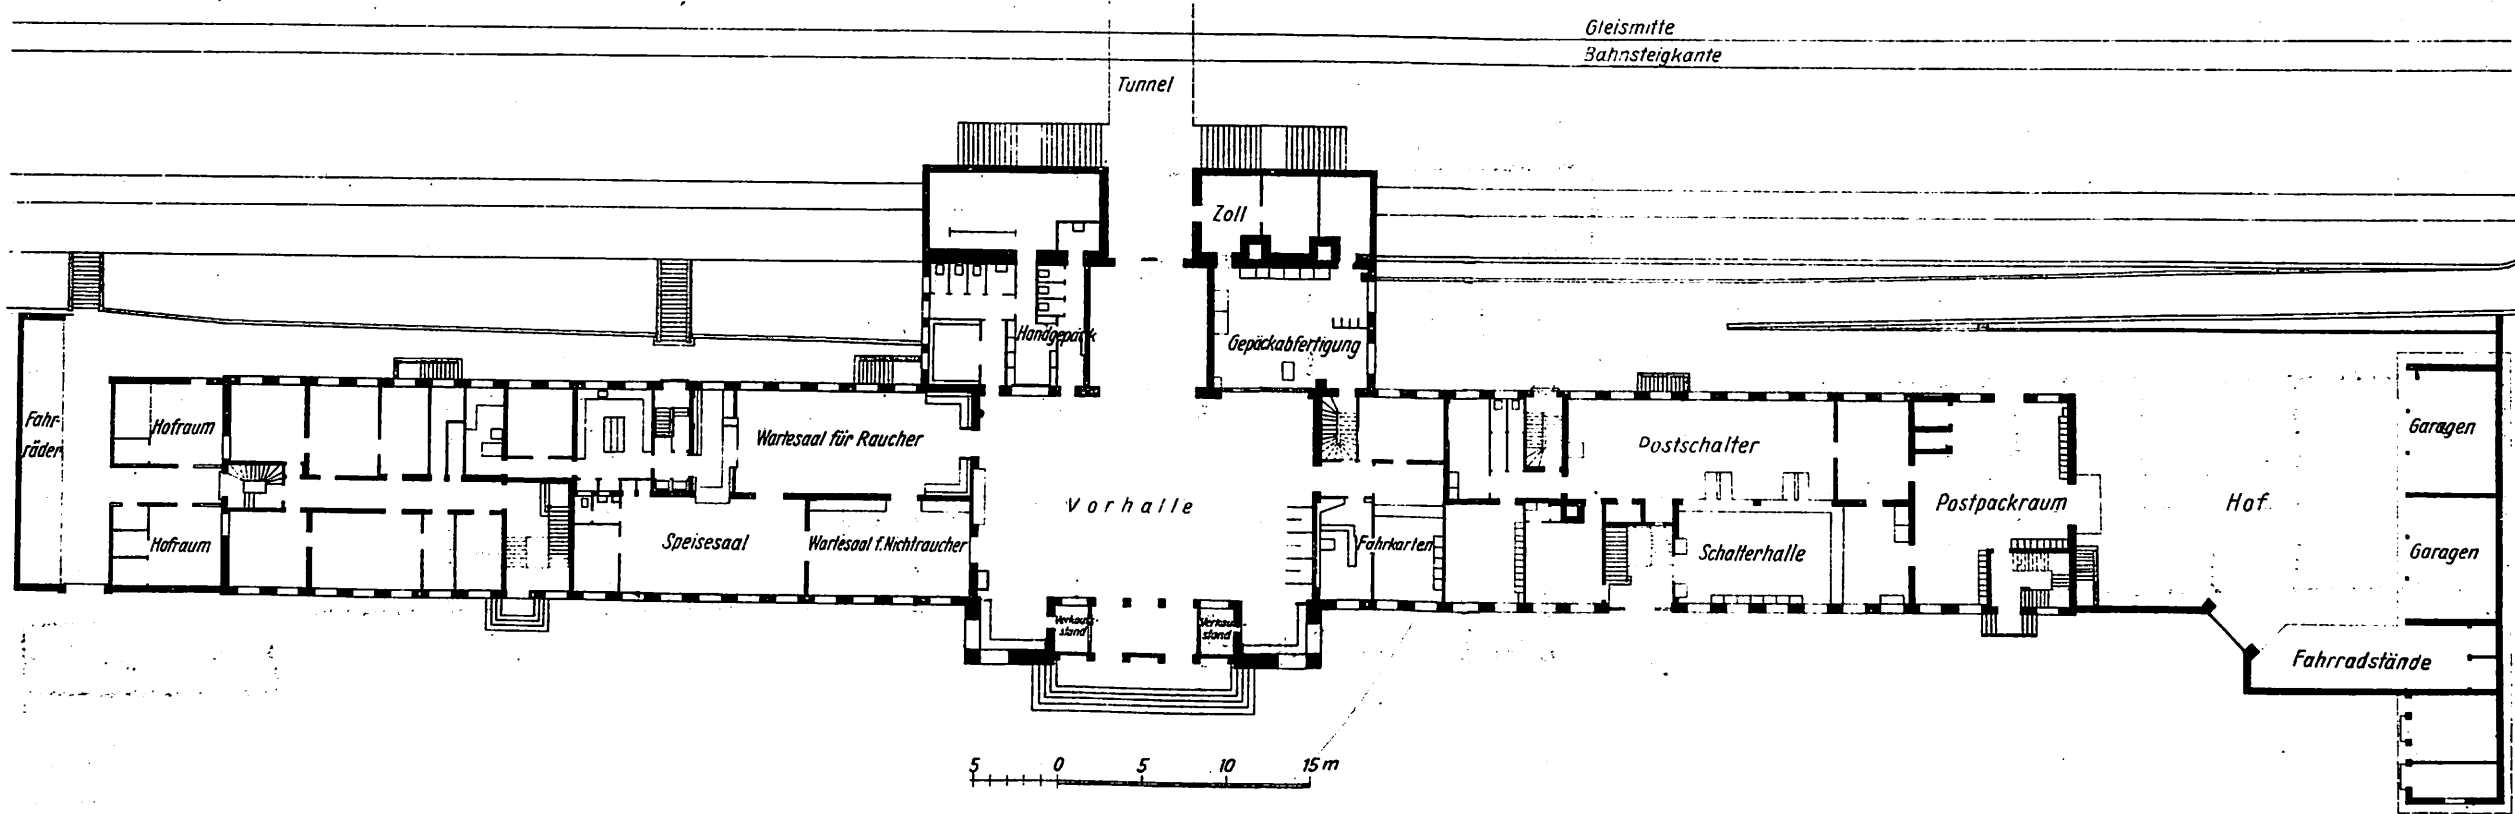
Erdgeschoßgrundriß des Empfangsgebäudes auf Bahnhof Fredericia
